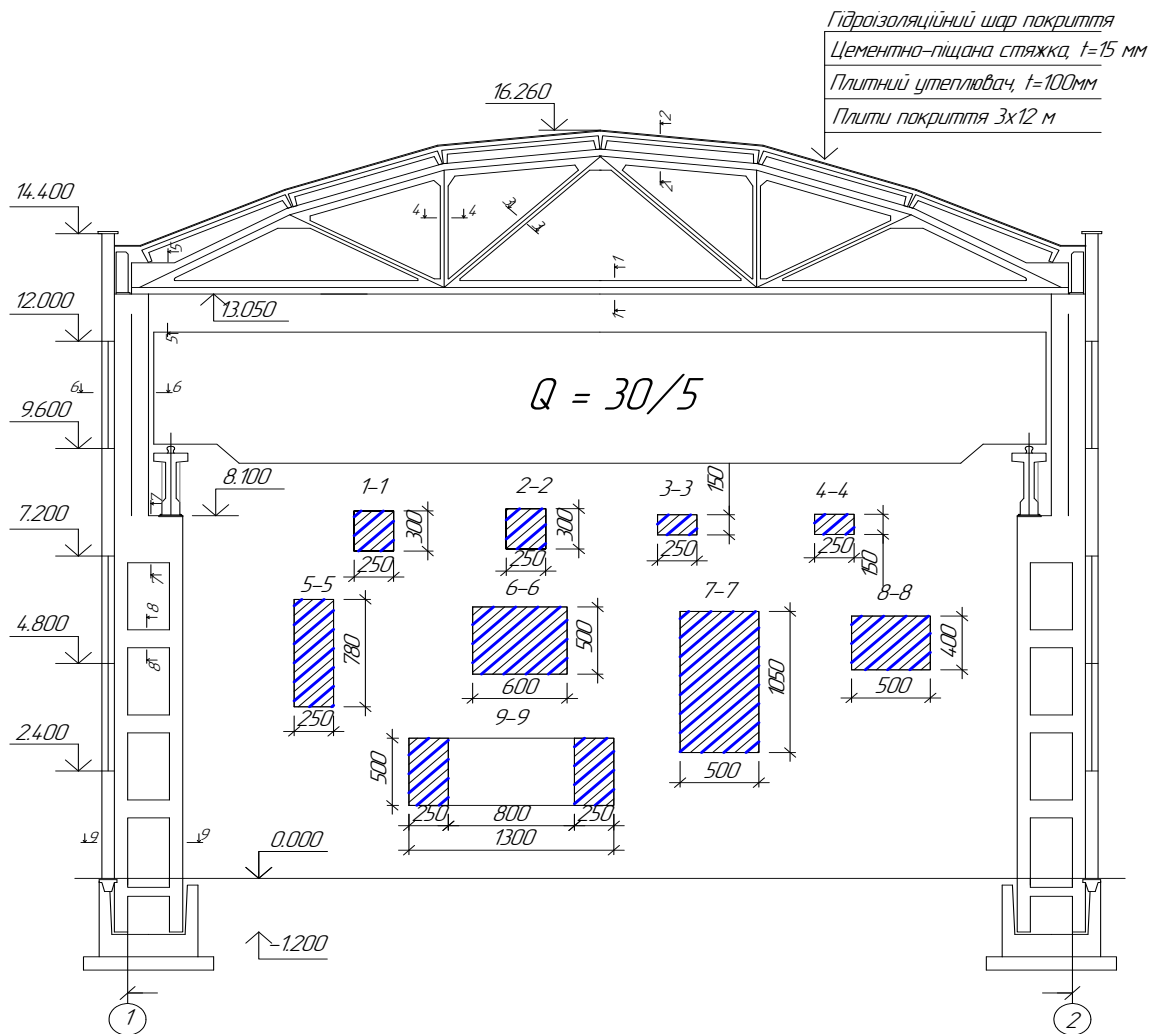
Поперечний переріз рами промислової будівлі
